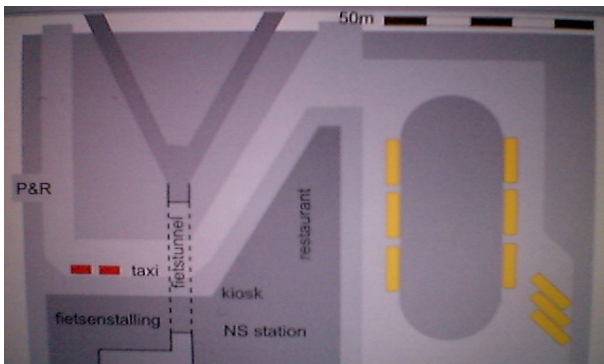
en 378 LINKS De Stedenbouwkundige detaillering rond stations wordt sterk bepaald door systeem eisen zoals taxistandplaatsen, Kiss & Ride voorzieningen en draaicirkels en het type opstelling van (bus)platforms en bus/taxi buffers. (Met dank aan T. De Jong)
